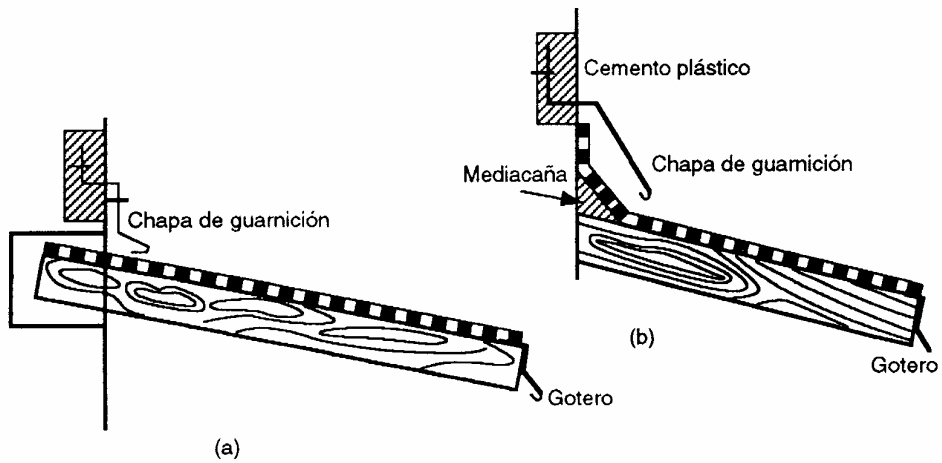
Impermeabilización en la transición entre superficies inclinadas y verticales de un techo de madera
